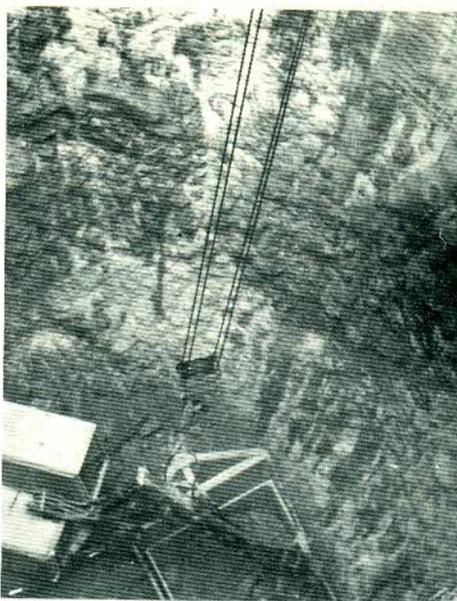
Lo scavo del pozzo n. 4 a circa 16 m di profondità. La tenuta della parete congelata e la stabilità dello scavo appaiono ottime □ The excavation of well no. 4 at a depth of about 16 m. The watertightness of the frozen wall and the stability of the frozen structure seem to be very good
